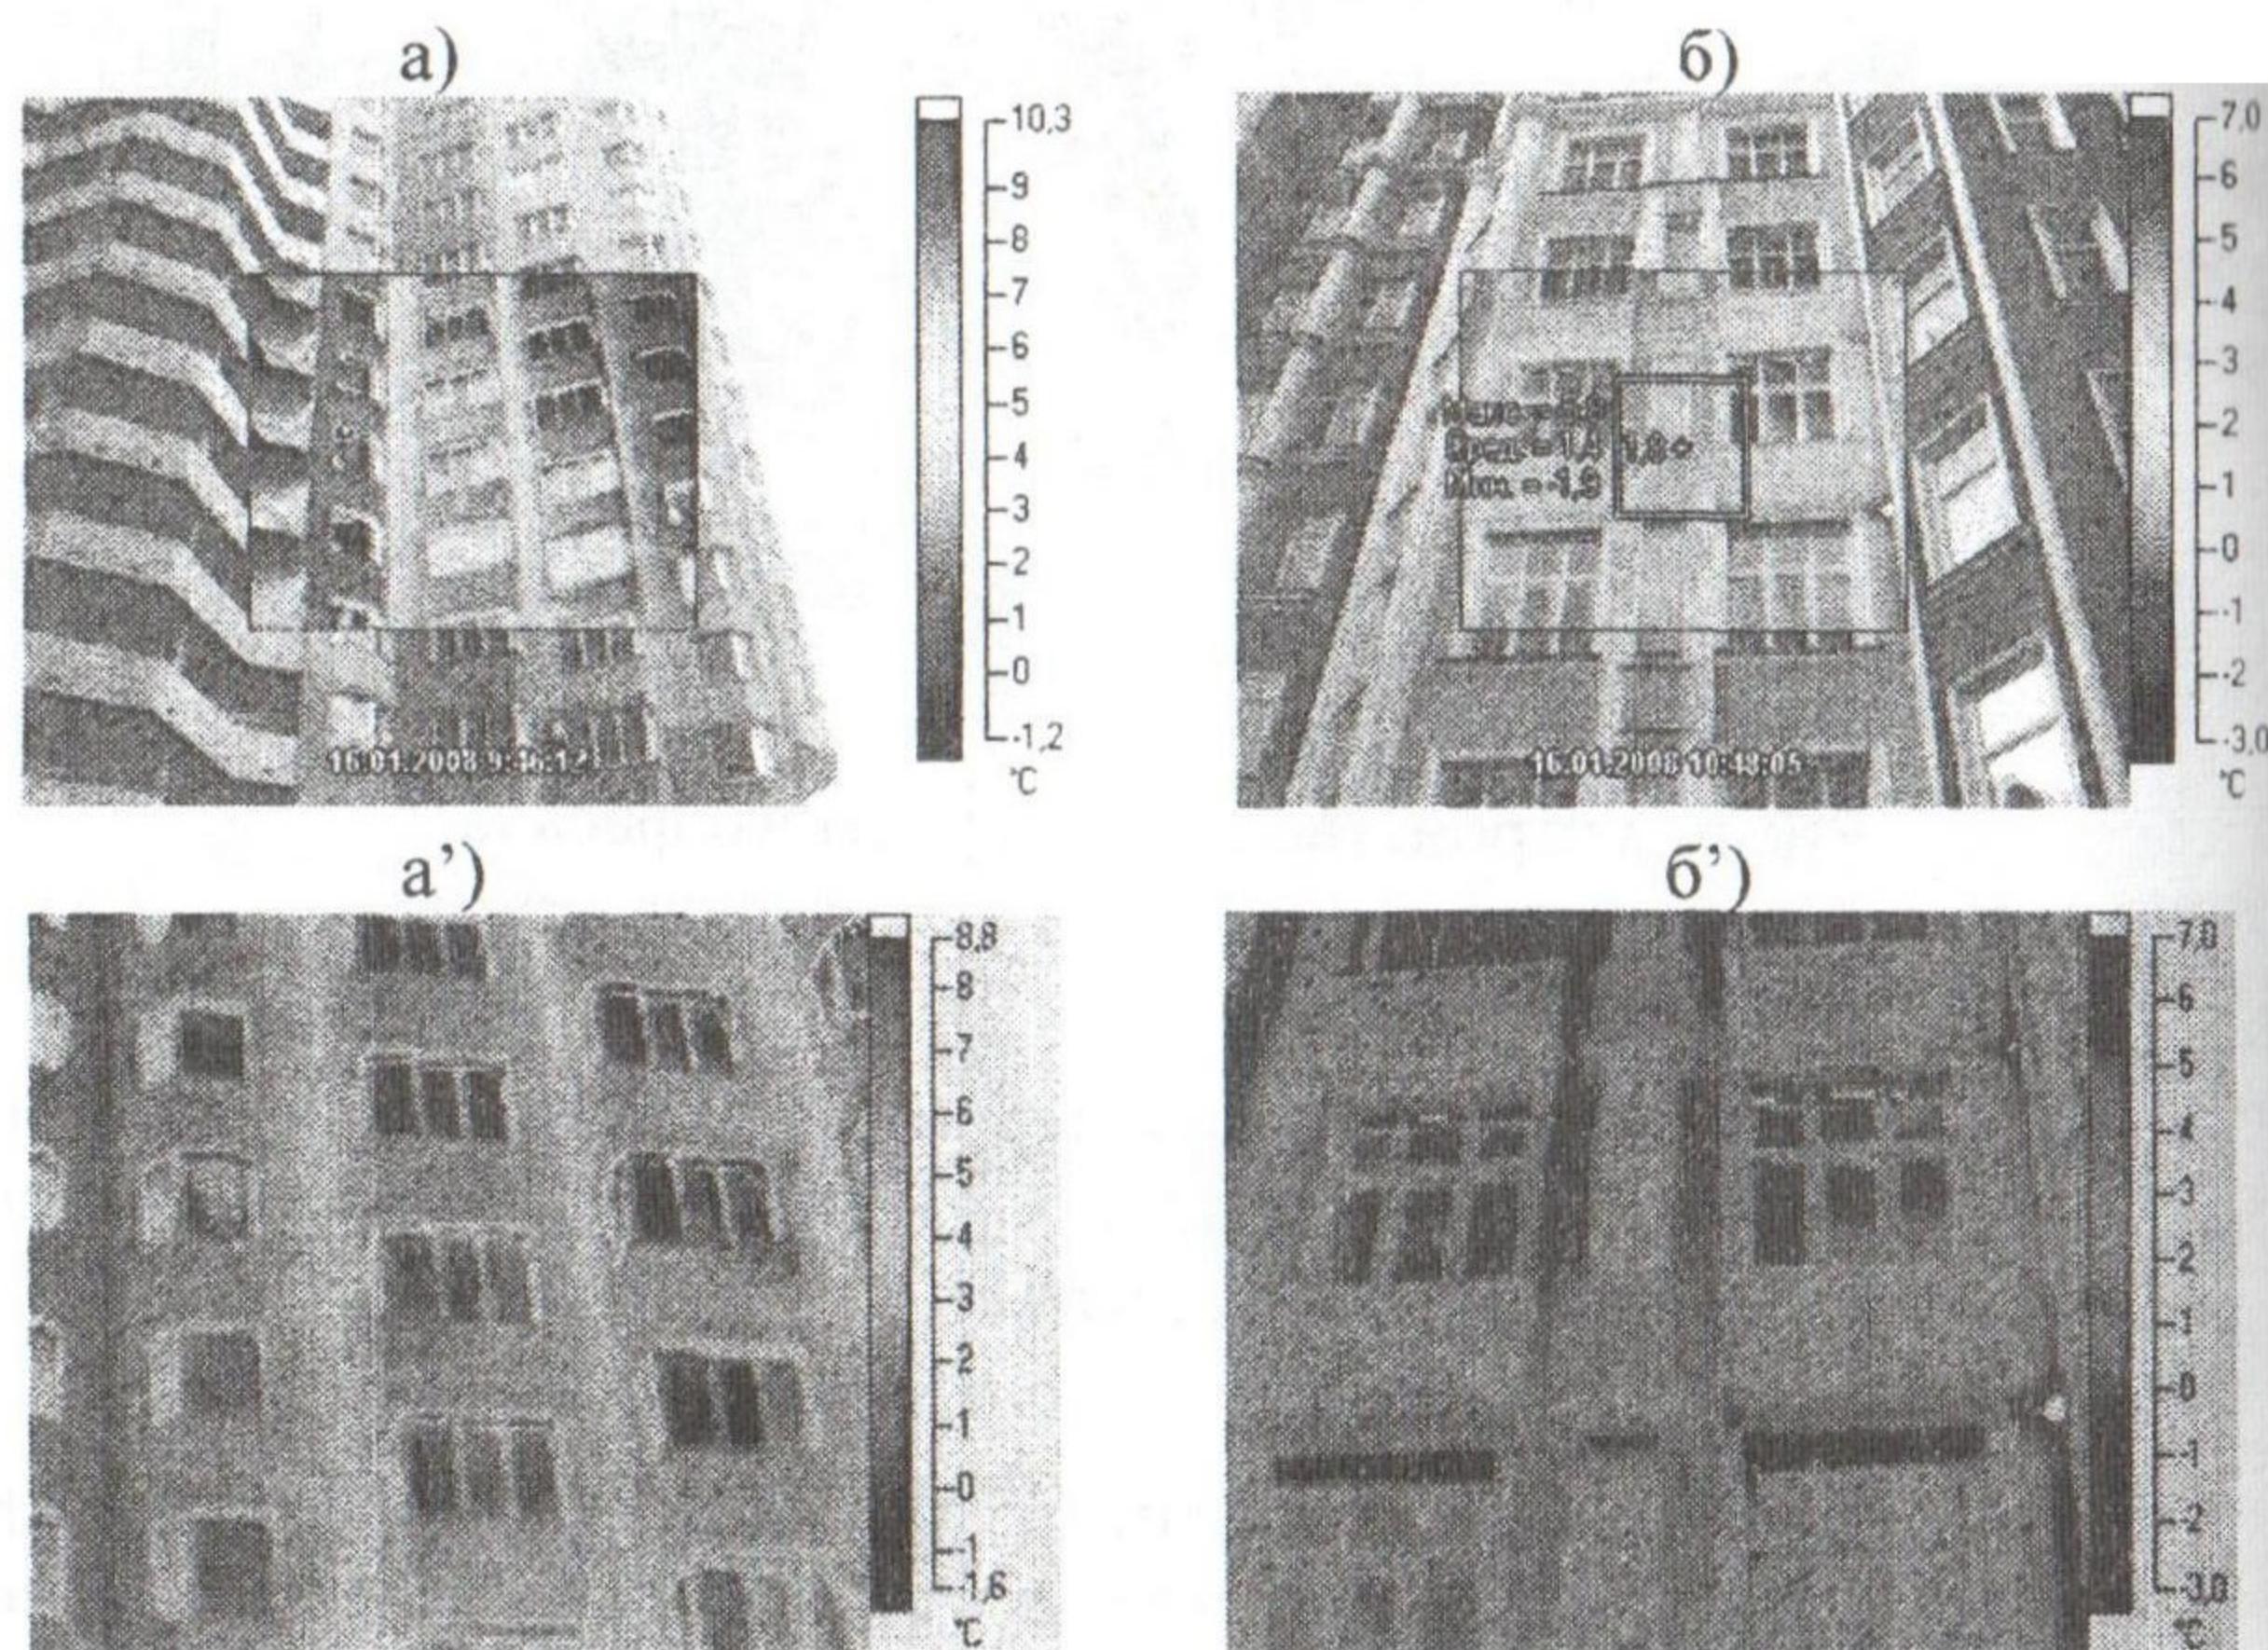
Фото с областью обследования (а, б) и термограммы (а', б') фасадов зданий утепленных системами скрепленной теплоизоляции:
